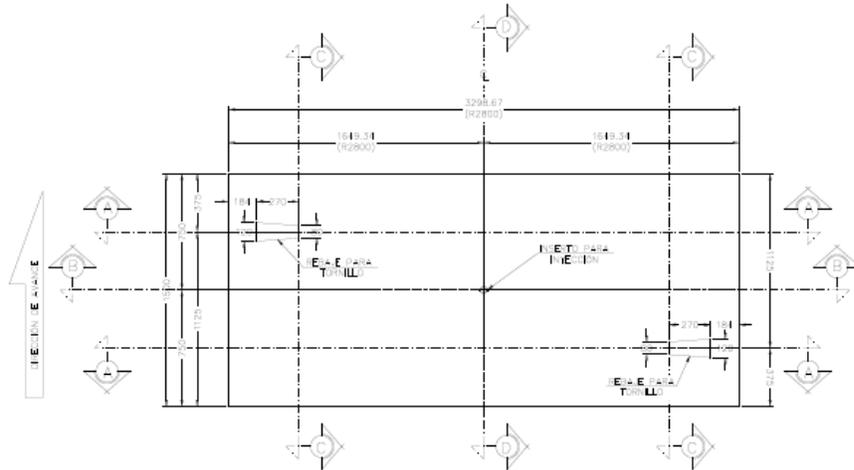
Vista superior en planta de la dovela A1 (cara interior del túnel).
